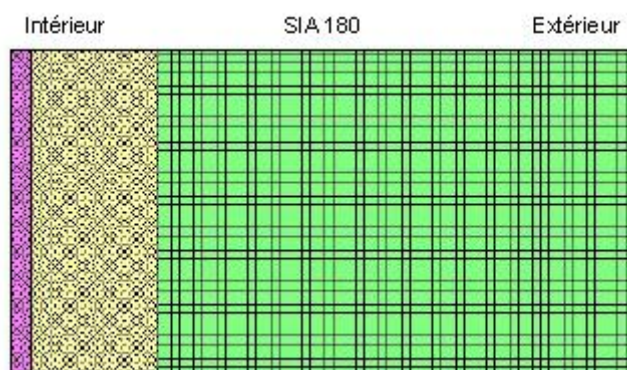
Façade 2<sup>ème</sup> étage (GD Climat, 2011)
